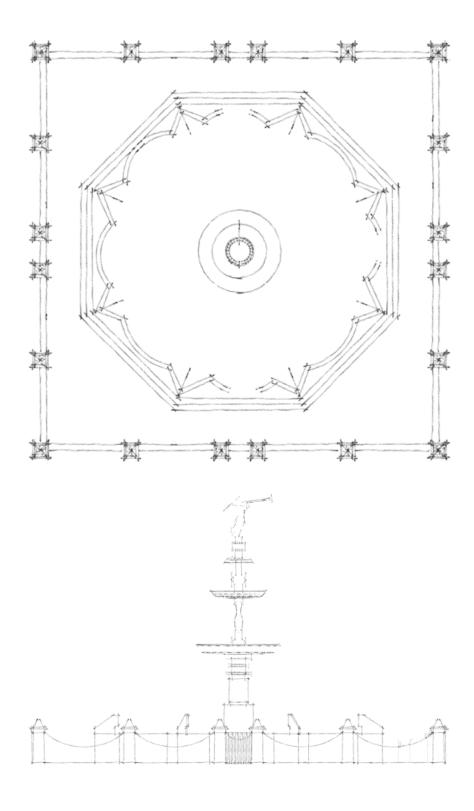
Planimetría de la fuente de la Plaza Mayor. Fuente: Elaboración propia con base a mediciones y a el levantamiento de Haydee.
